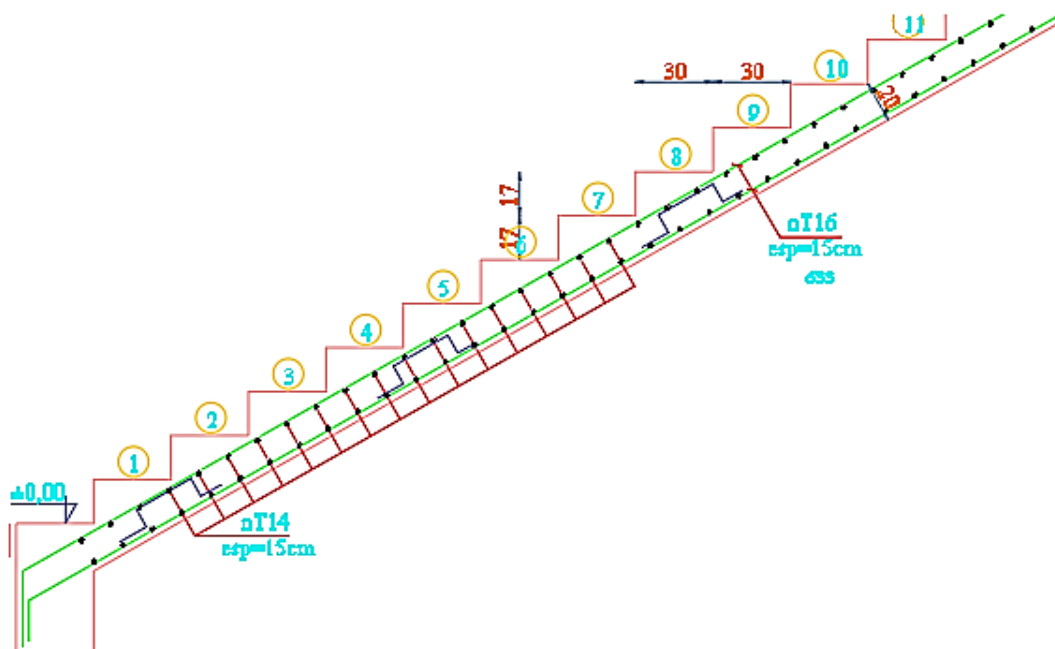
Schéma du ferrailage des escaliers partie inférieur
